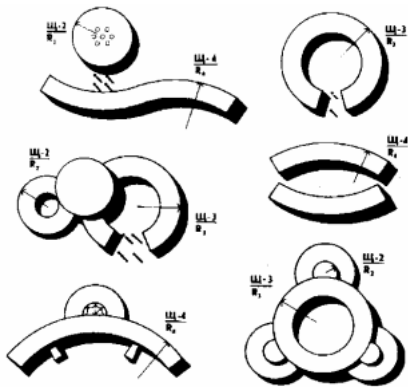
Формування криволінійних будівель на основі монолітного залізобетону (по методу переставної опалубки)
